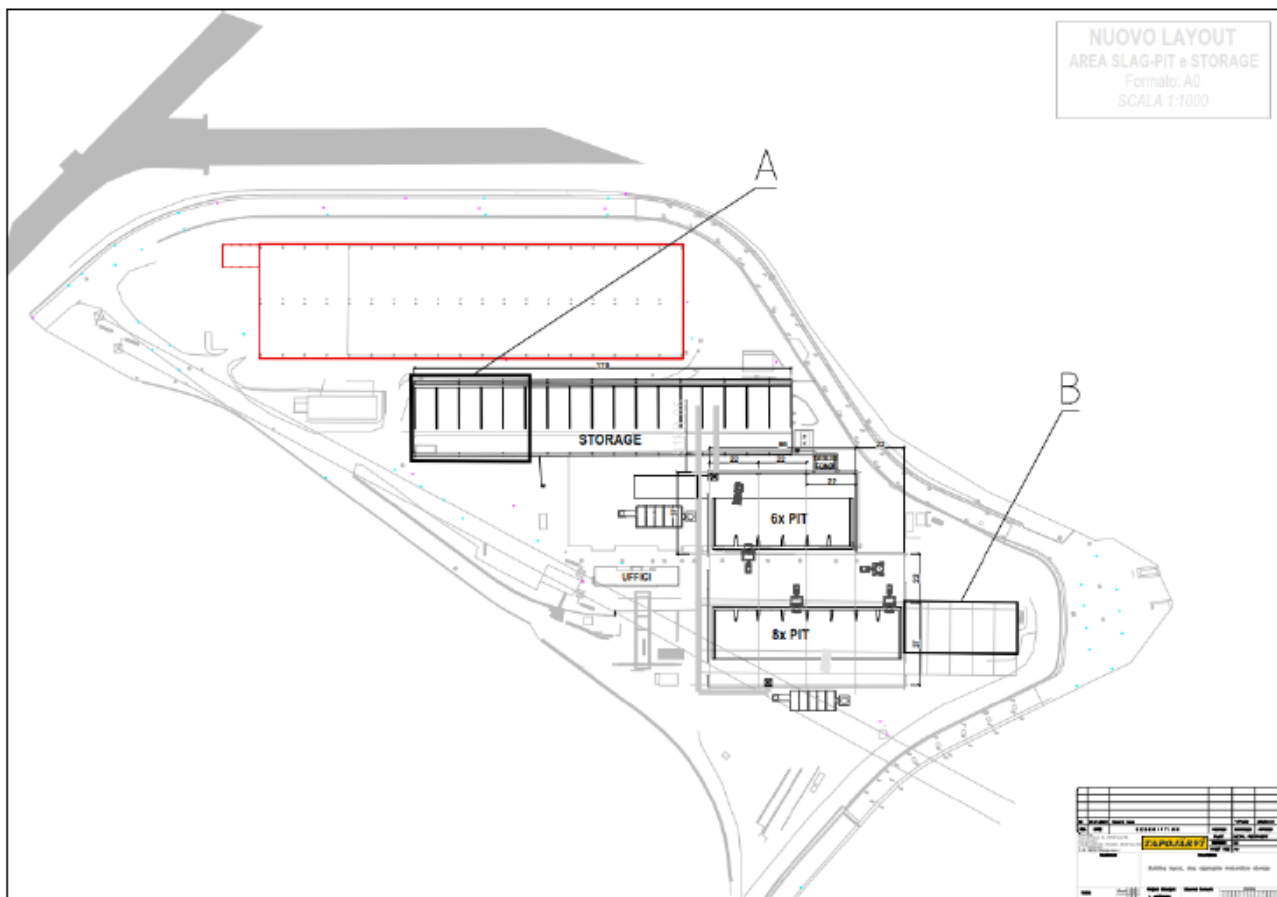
Individuazione dell'edificio di stoccaggio temporaneo (A) e dell'edificio di stoccaggio finale
